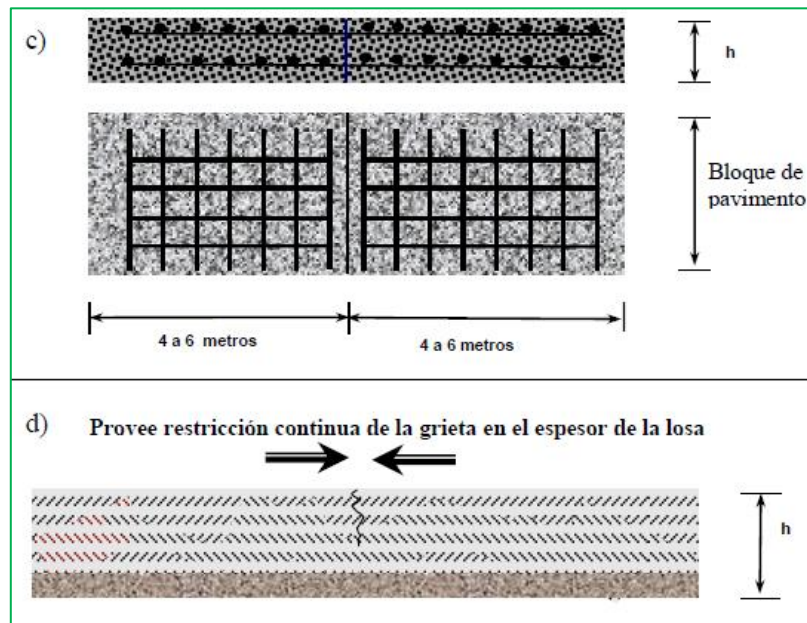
c) Pavimento de concreto con refuerzo estructural. d) Sección transversal de un pavimento de concreto con fibras de acero. Fuente: Pavimentos de Concreto para carreteras. (Ref. Bibliográfica 5)
